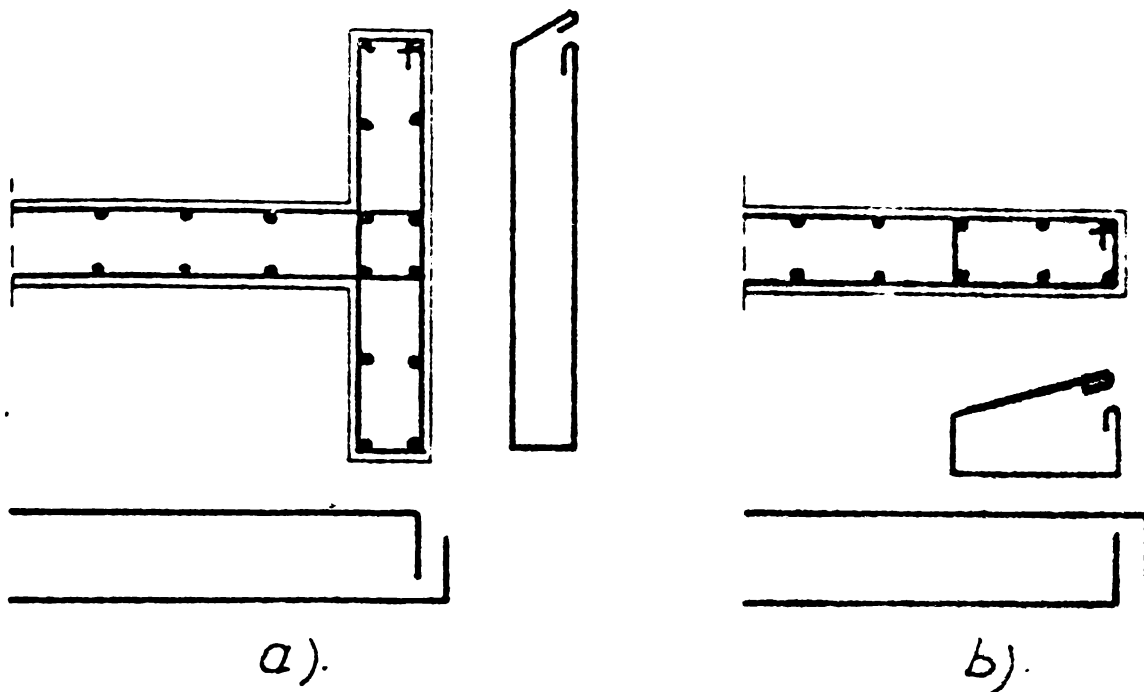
Capete de diafragme cu bulbi și fără bulbi cu armarea cu rețea din bare independente
